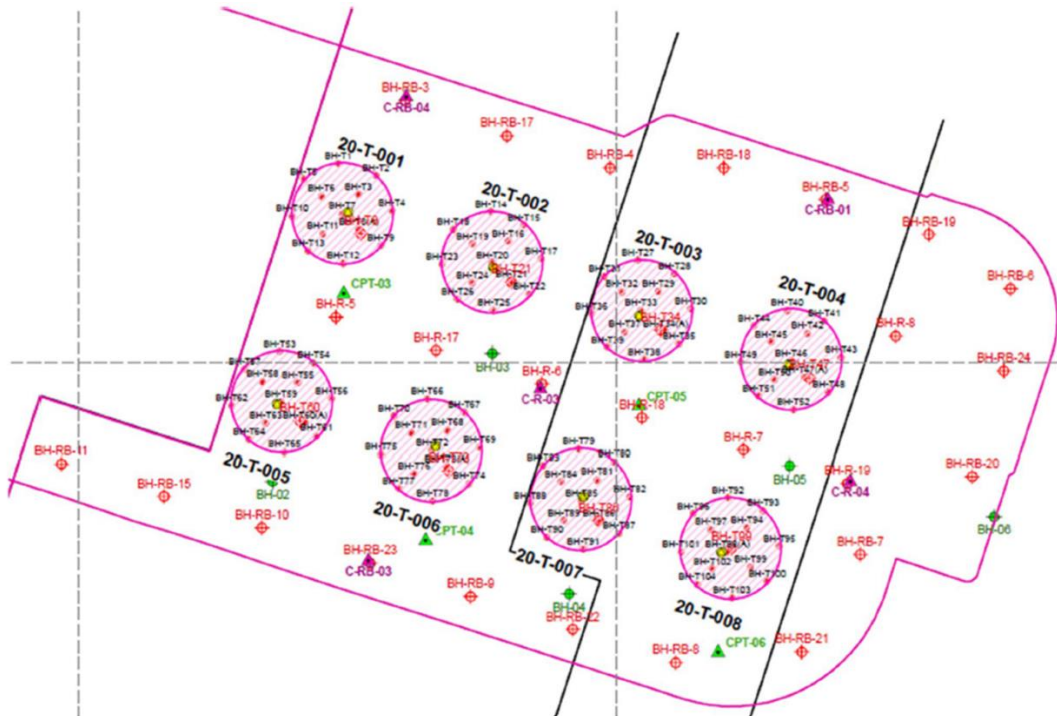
Planta de localização dos tanques e dos ensaios de campo (Bernuy et al., 2018)
